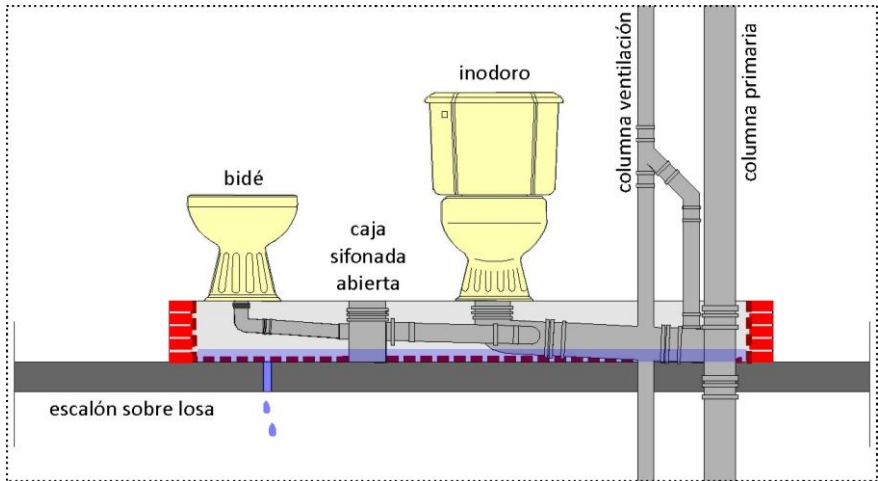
Escalón sobre losa con impermeabilización por debajo de la cañería.
